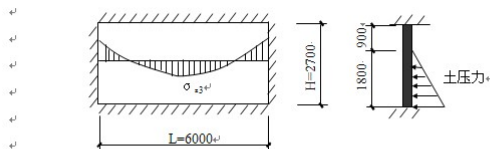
在侧向土压力作用下钢筋混凝土外墙内力计算简图
